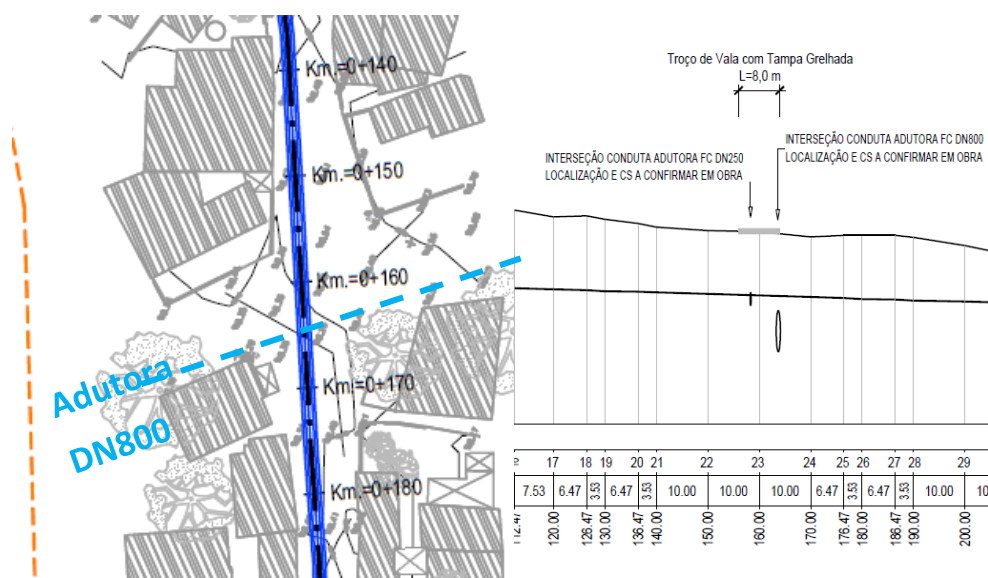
Condicionante – Cruzamento de conduta adutora DN800 com vala proposta (Planta e perfil)
